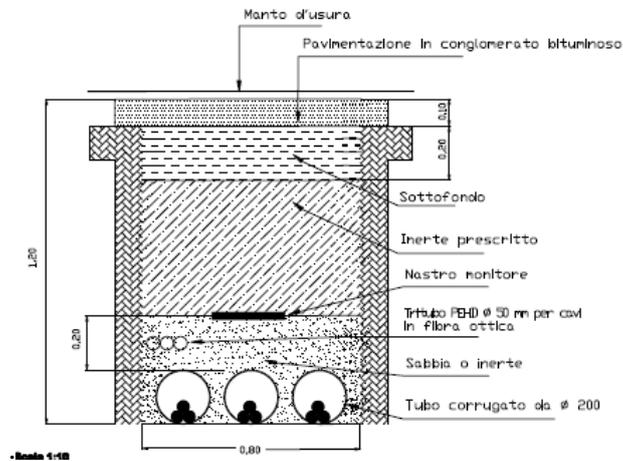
Sezione su strada asfaltata - posa di n°3 cavi MT
